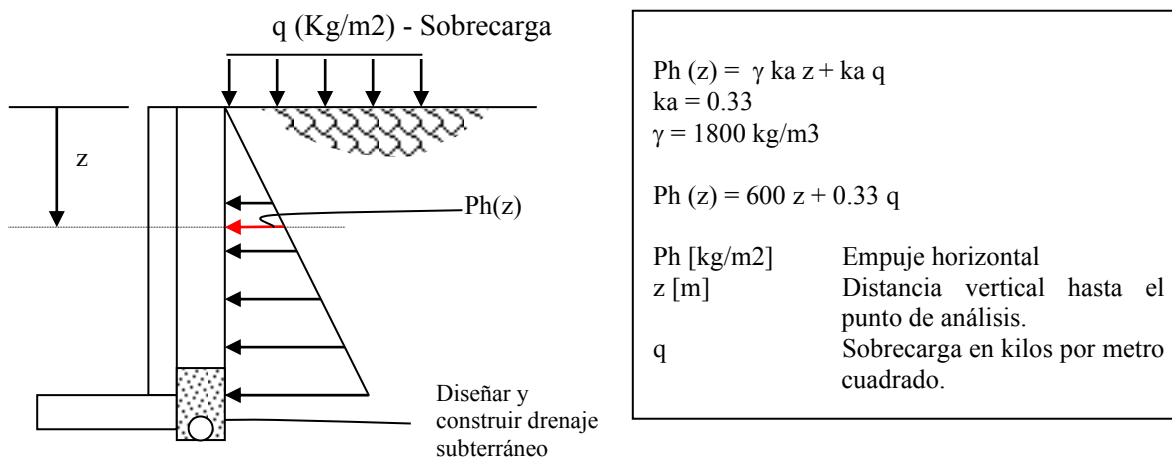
Esquema de Empujes Activos para Diseño de Muro
